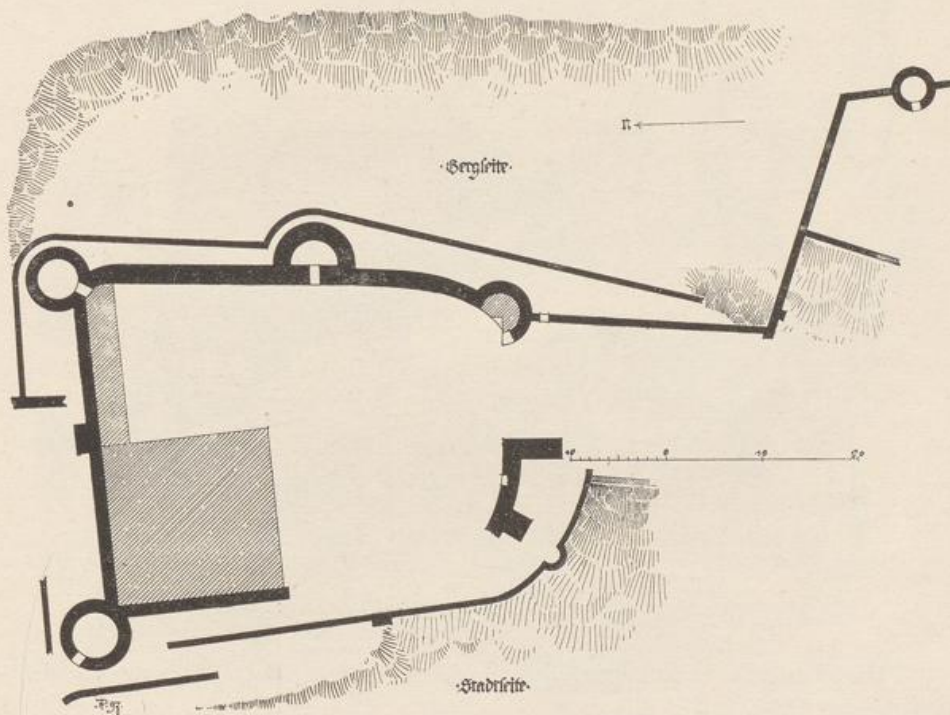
MünsterEIFEL. Grundriss der Schlossruine.
